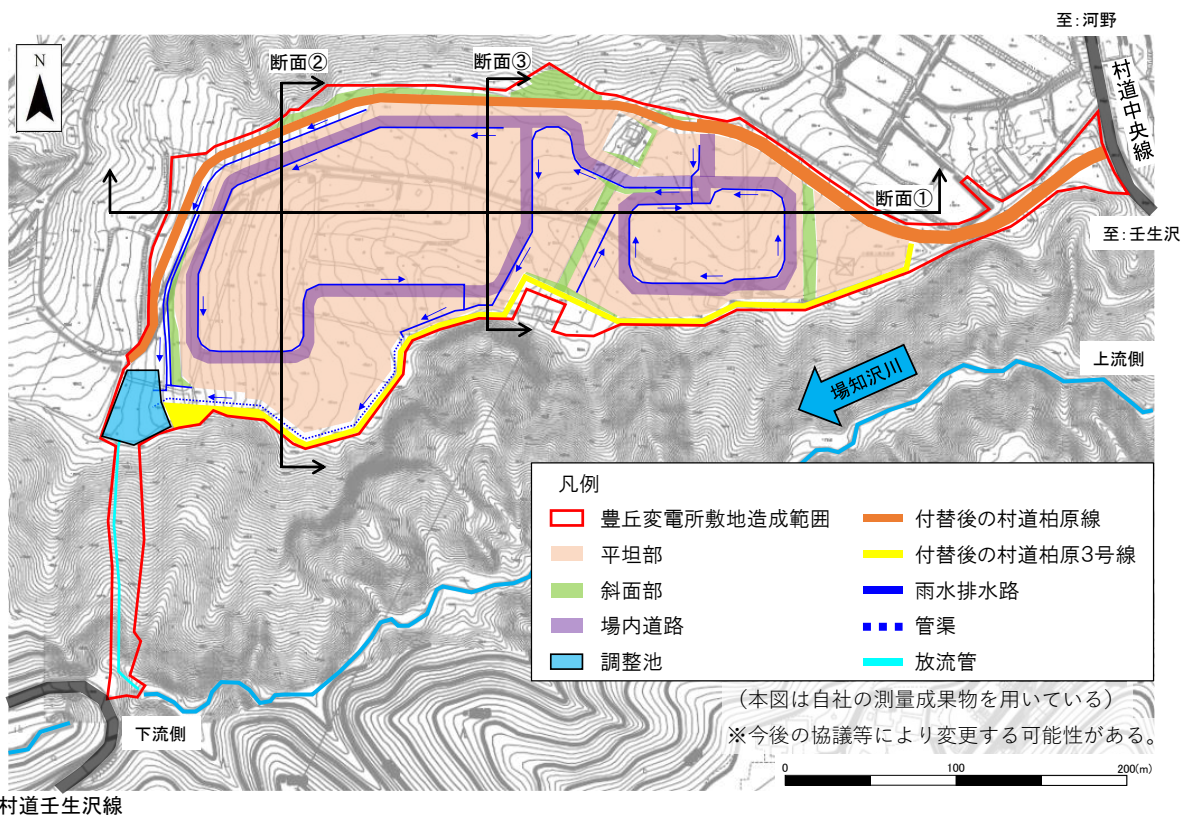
(1) 豊丘変電所敷地造成の計画平面図
